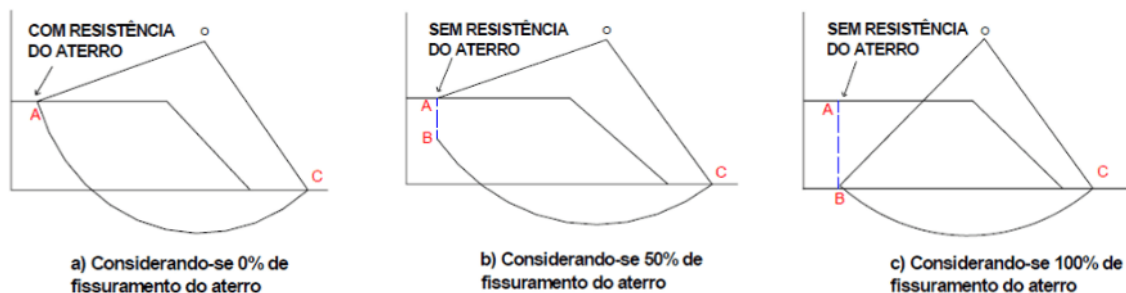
Superfície de ruptura passando pelo trecho fissurado.
